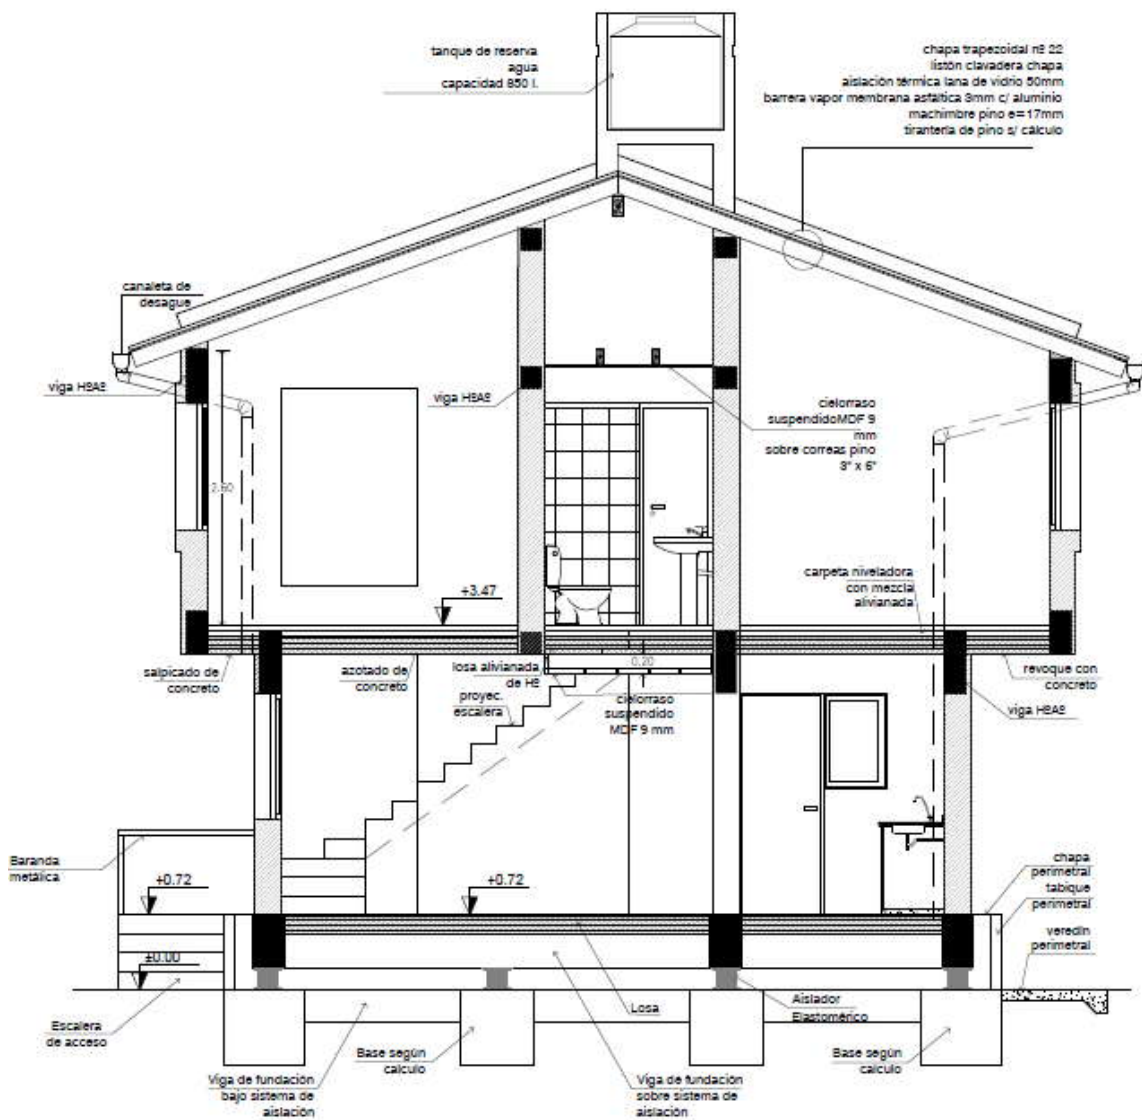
Corte de la vivienda aislada de dos plantas.
